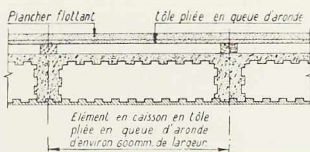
Coupe dans le plancher du 1^{er} étage.
